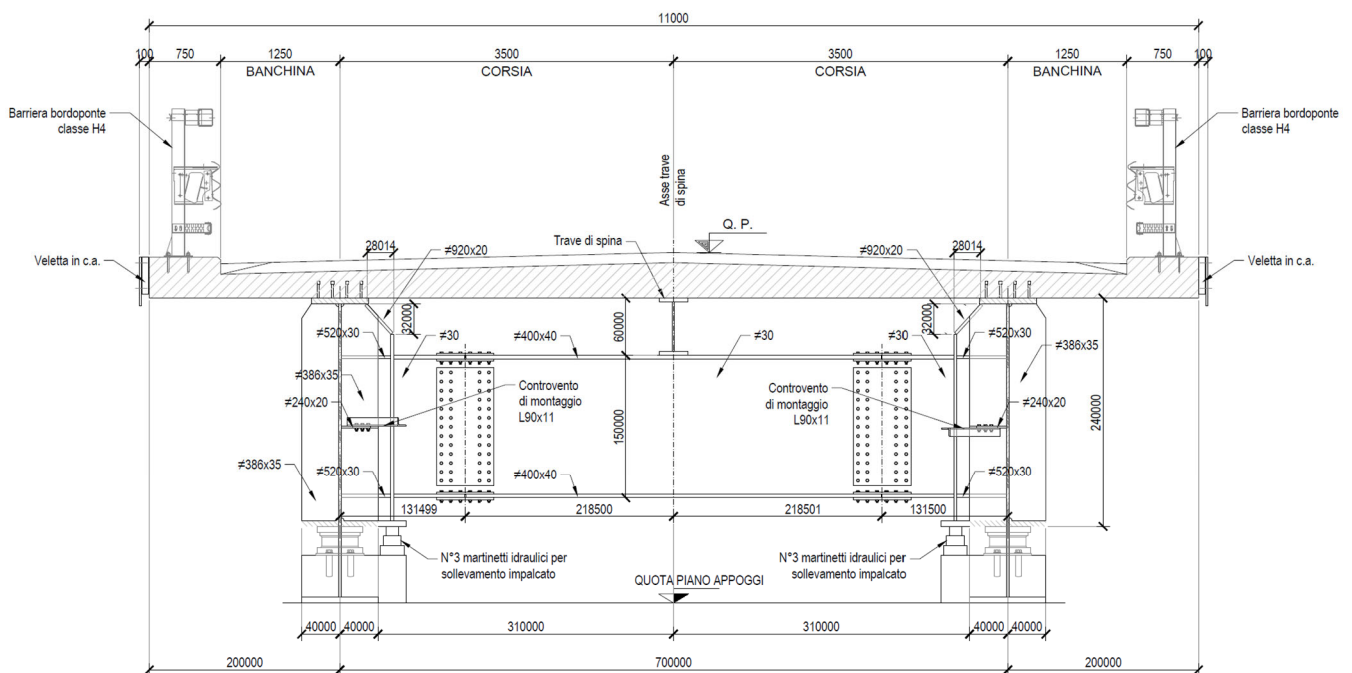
Sezione trasversale dell'impalcato su asse appoggi
